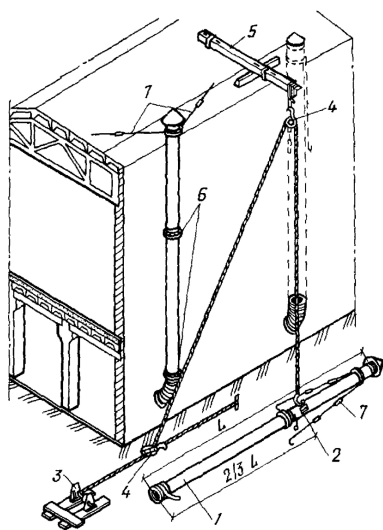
Схема организации рабочей зоны при монтаже вертикальных воздуховодов по наружной стене здания: 1 - укрупненный узел воздуховода; 2 - полуавтоматический строп; 3 - лебедка; 4 - блок; 5 - консоль; 6 - кронштейны; 7 - растяжка
